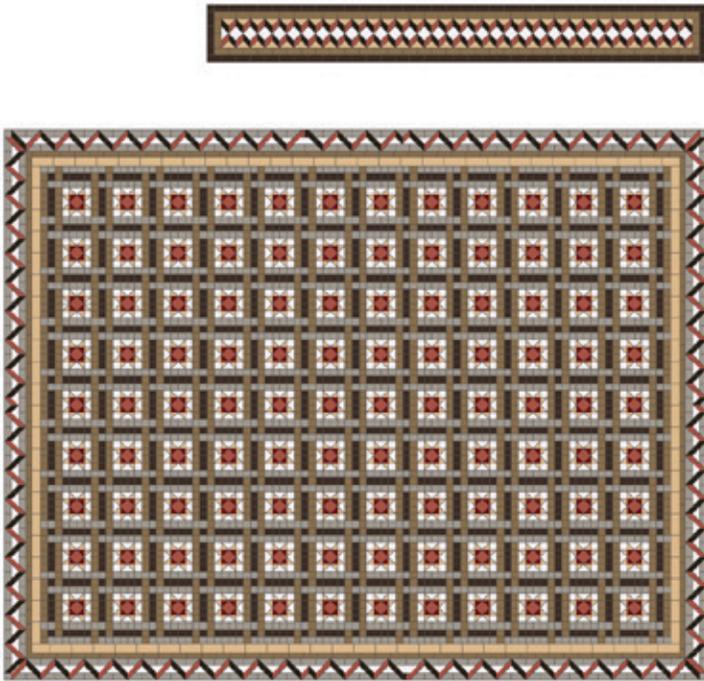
Villa Morris. Pavimento de cerámica Nolla del distribuidor y el acceso en planta baja. Fuente: Autores.
